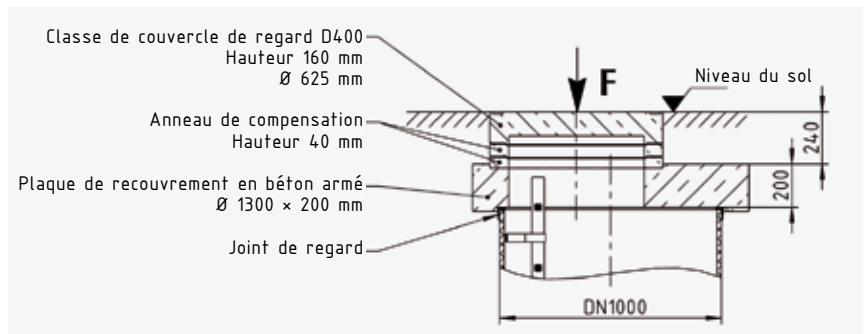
| Plaques de recouvrement à protection contre le retournement
